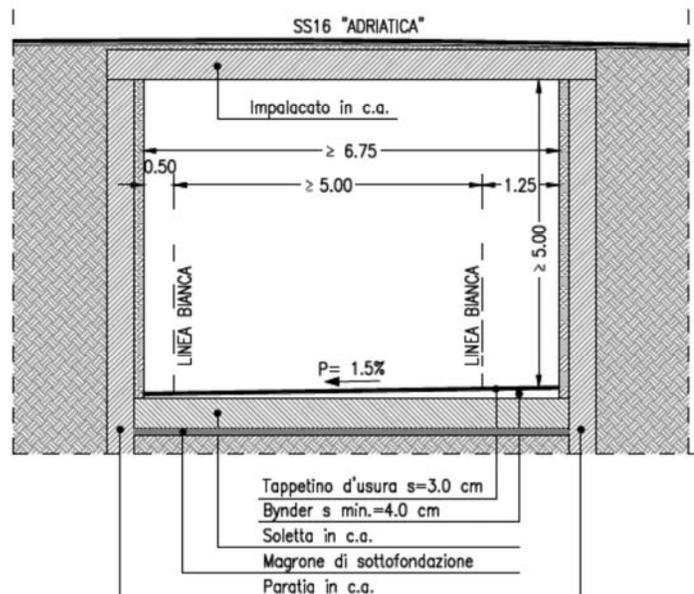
e – Sezione tipo del sottopasso via Tosca-SS16
